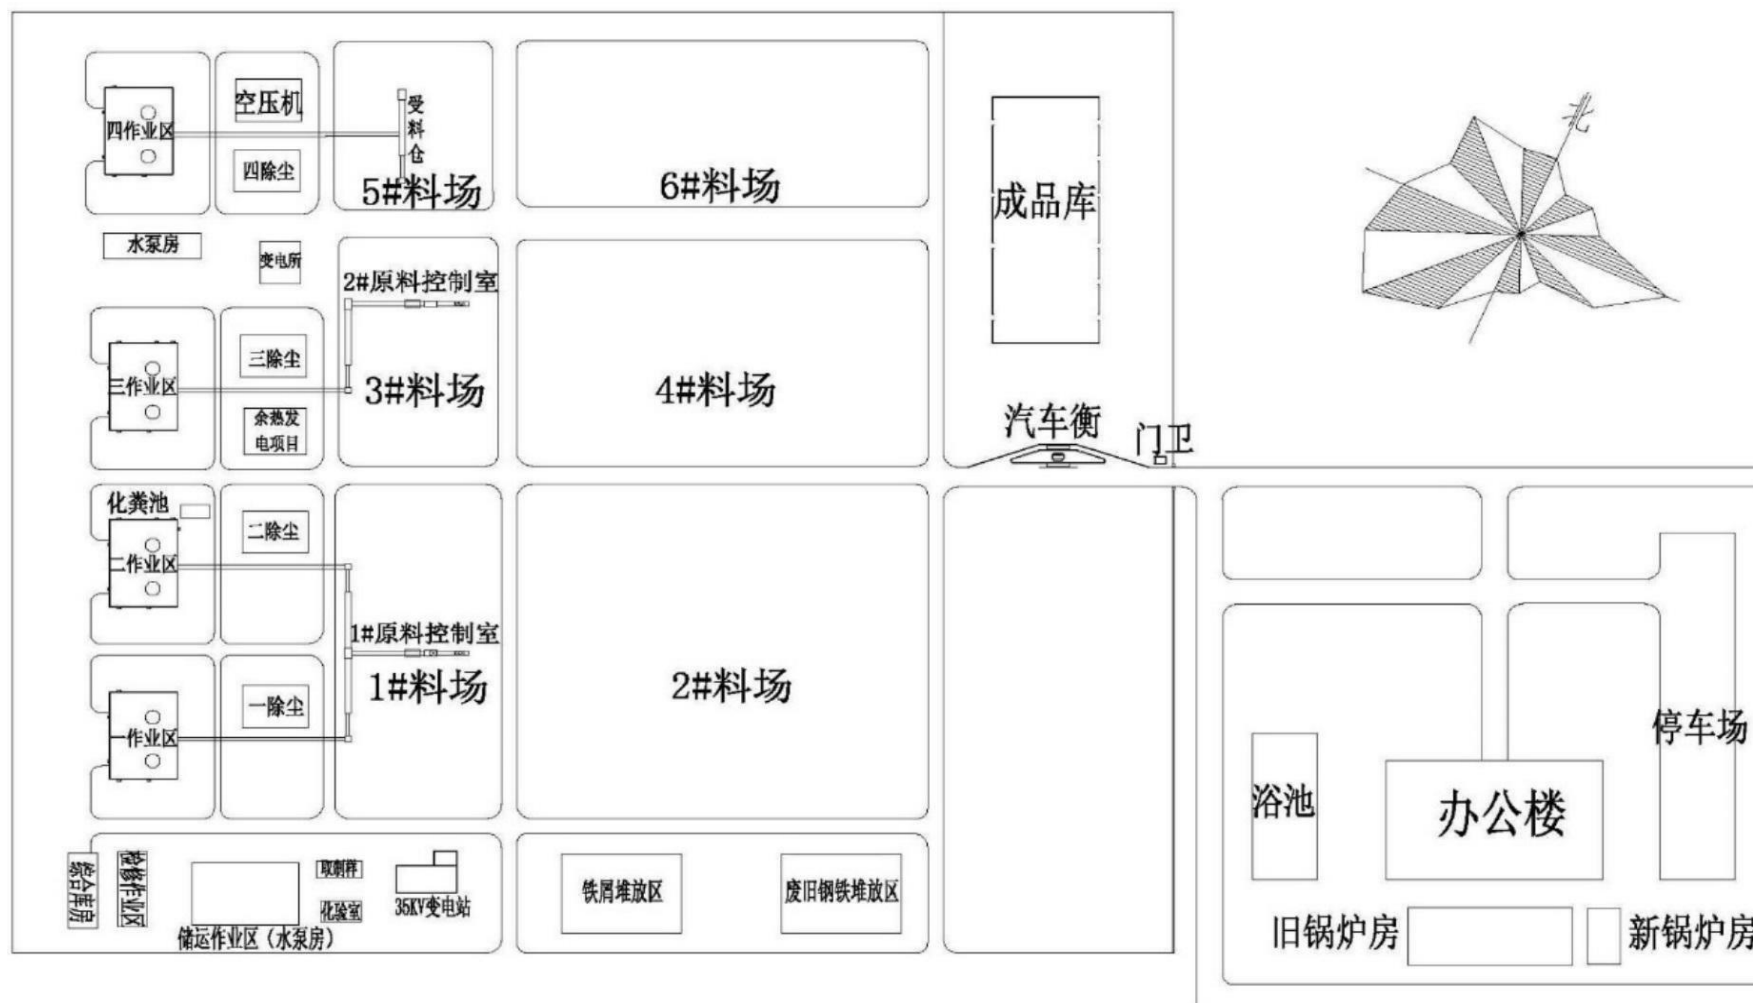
嘉峪关宏电铁合金有限责任公司厂区平面布置图
